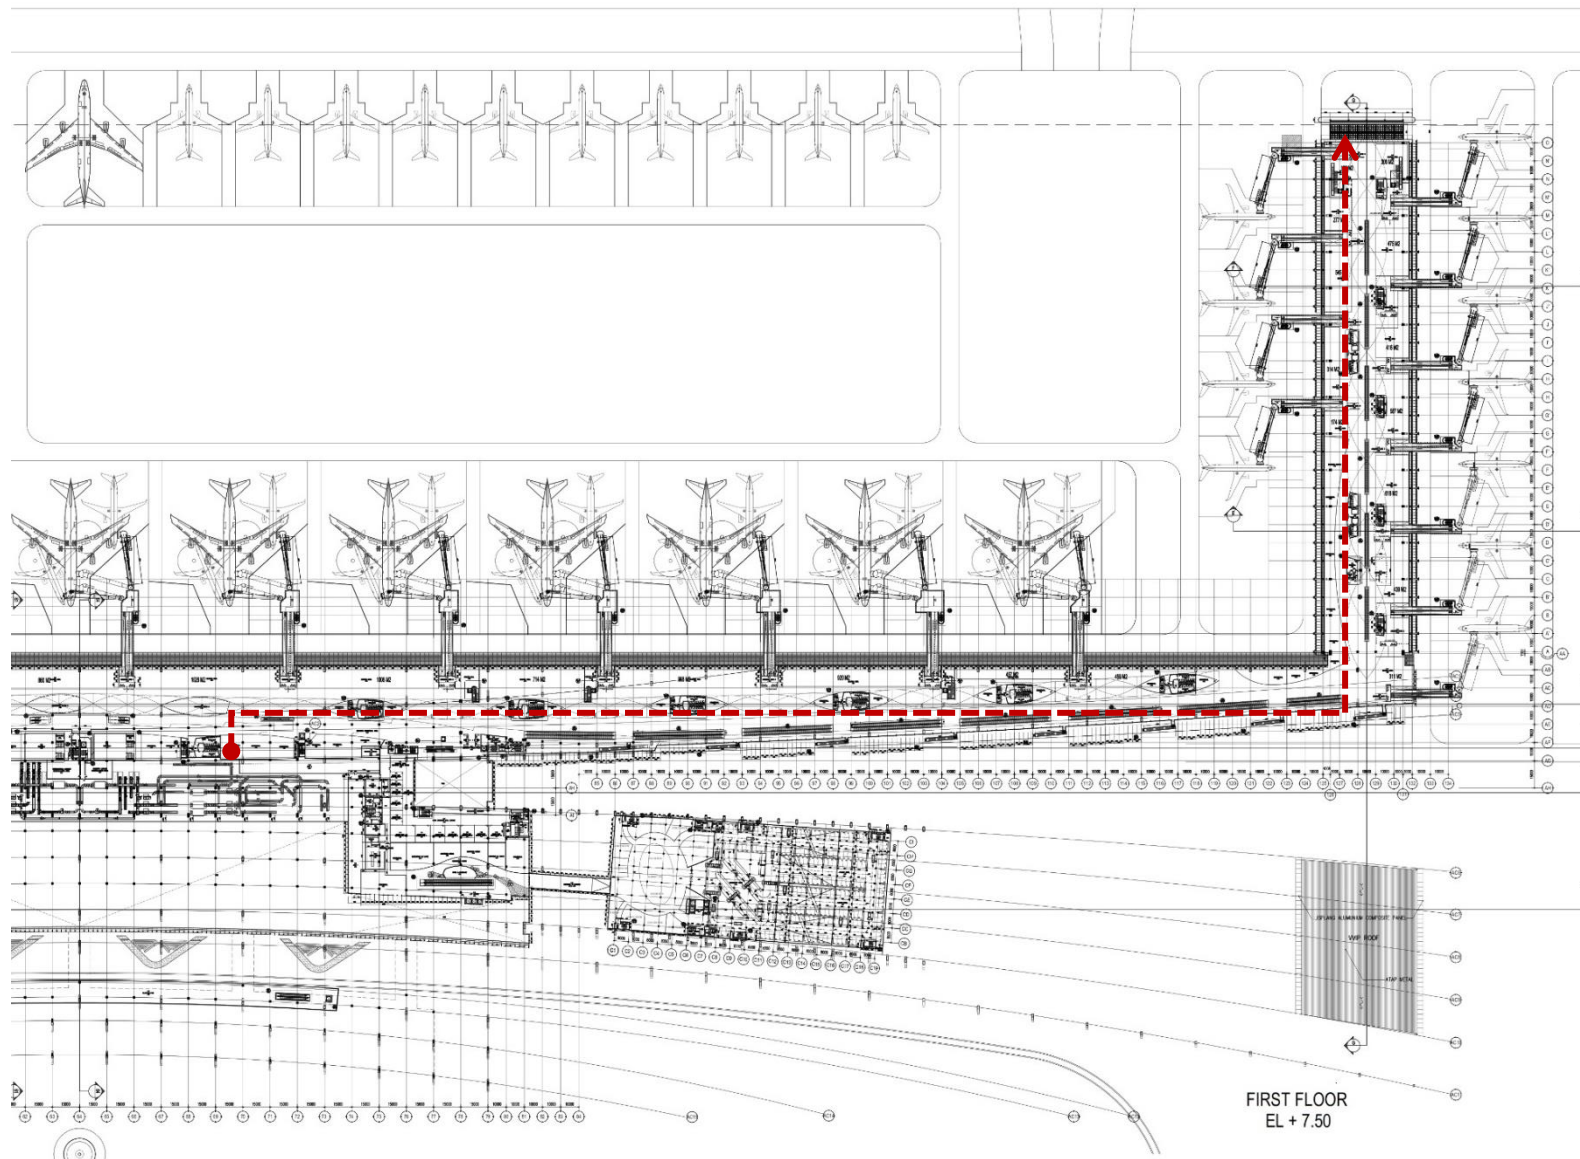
Denah Lt.3 Terminal 3 dengan Jarak 434 m Dari *Curb Side* Atau *Drop Off* Sampai Akses Turun Ke *Boarding lounge
